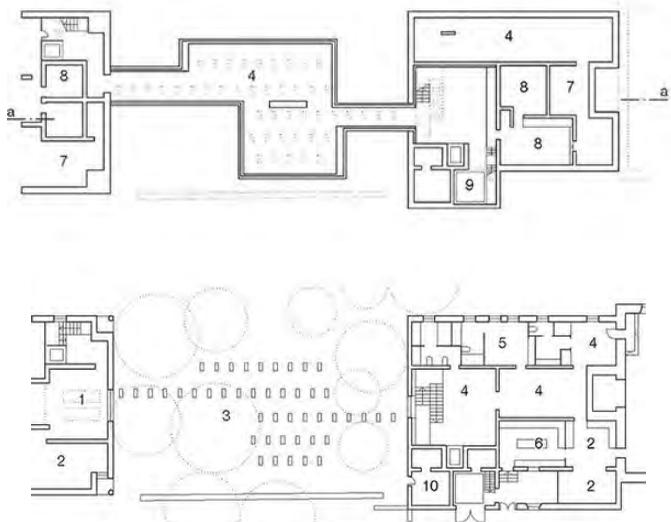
Grundrisse, Galerie la Pizarrera
